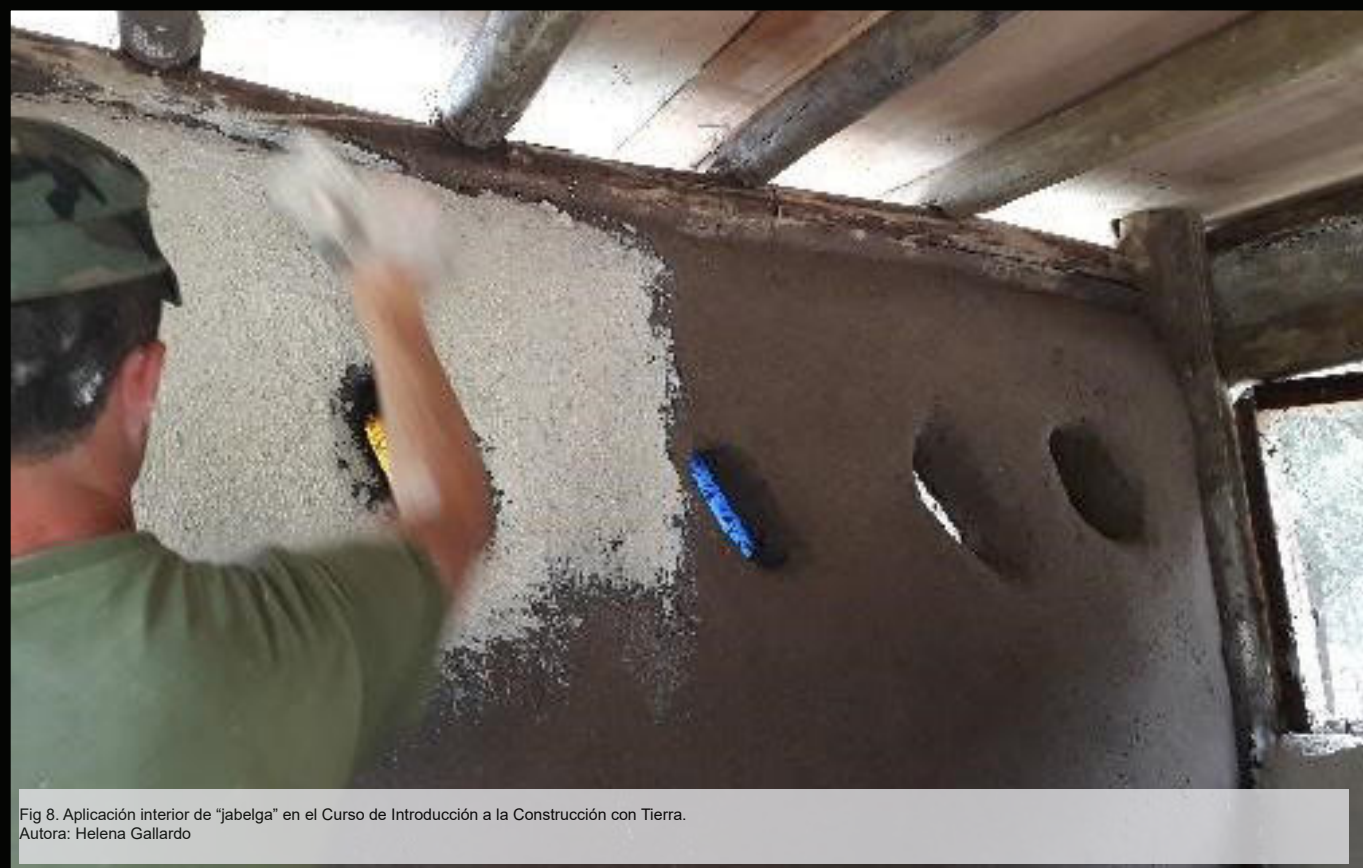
Aplicación interior de "jabelga" en el Curso de Introducción a la Construcción con Tierra.
